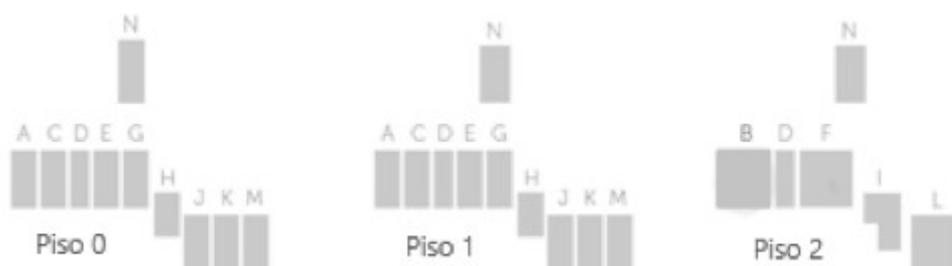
Perspectiva geral sobre o empreendimento – (Fonte: Adaptado de Planta de Arquitetura, 2019)
